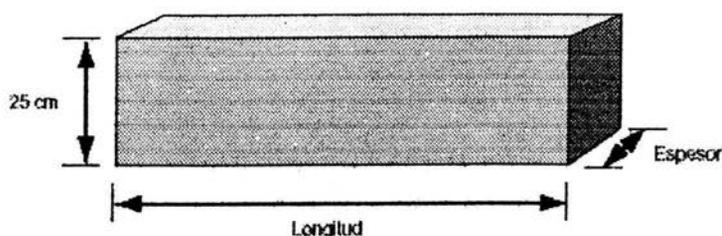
Dimensiones de dintel cargador de 25 cm de peralte
